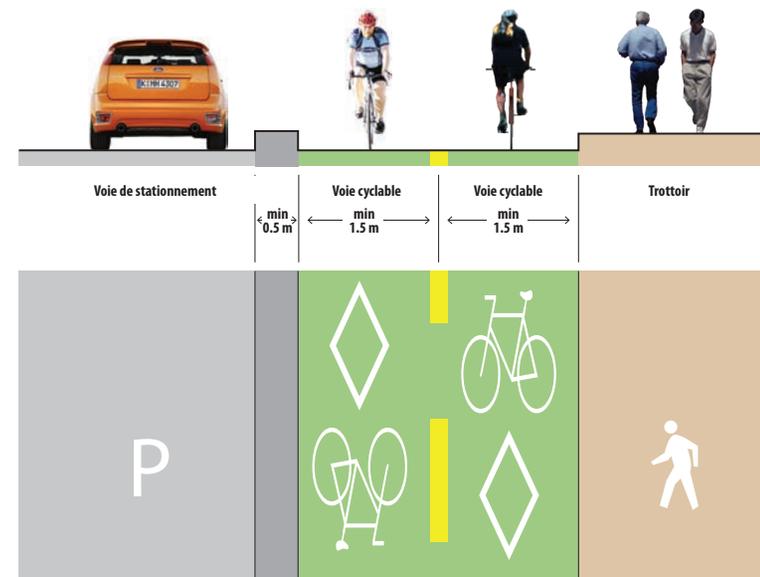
Installation bidirectionnelle séparée latéralement avec stationnement
